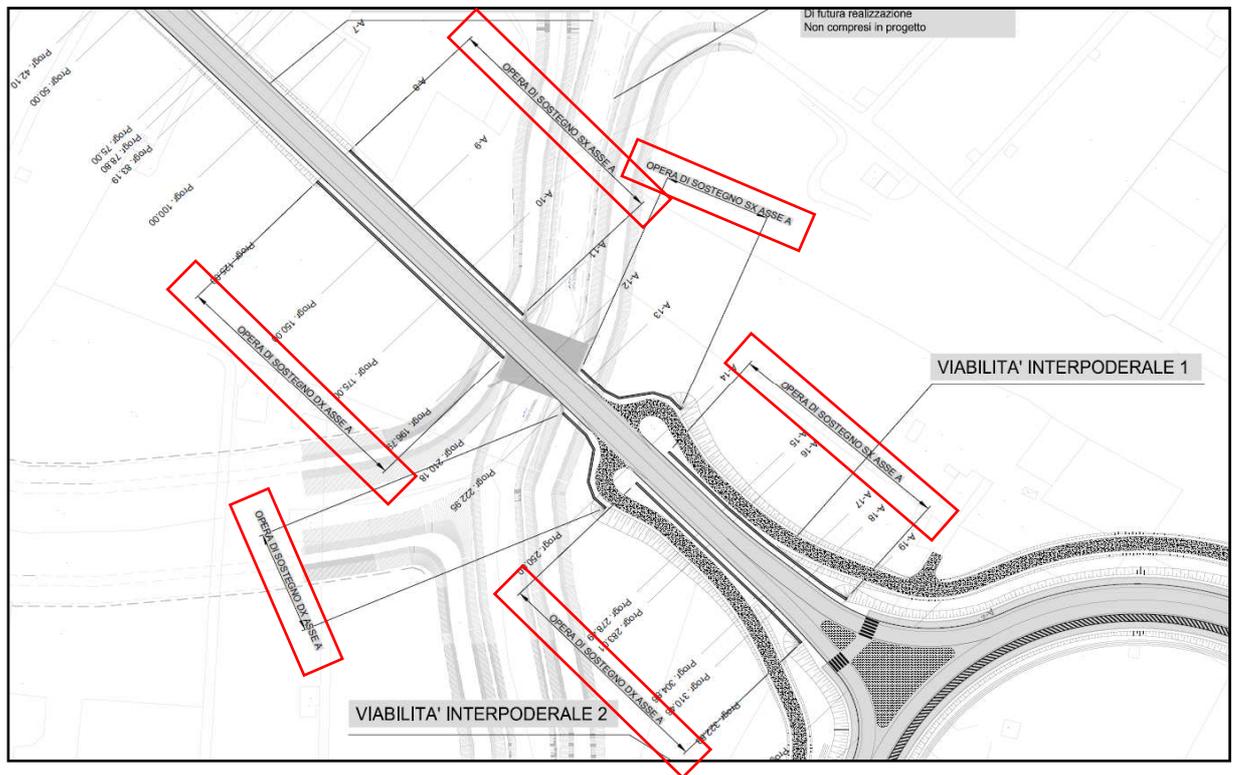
Stralcio planimetrico dell'asse A con individuazione delle opere di sostegno.
